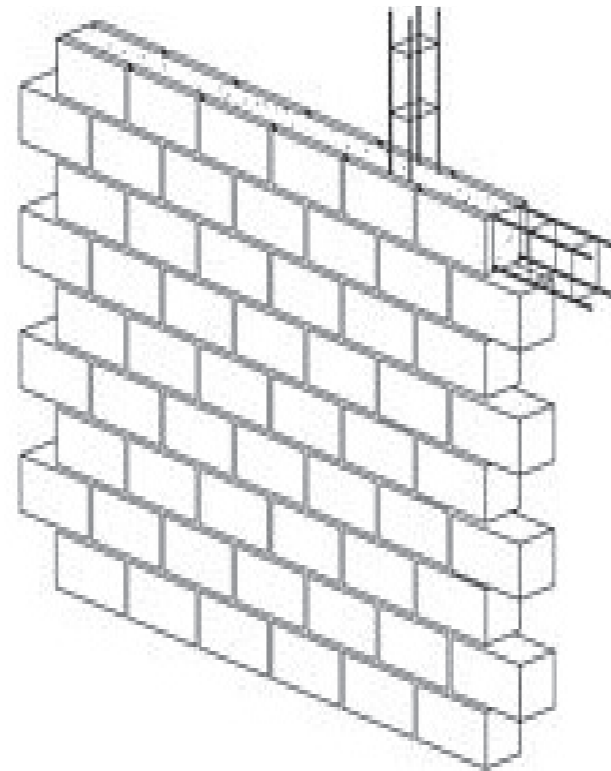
Refuerzos horizontales y verticales dentro de muros de mampostería. Tomado de (Sólo Arquitectura, 2015)
